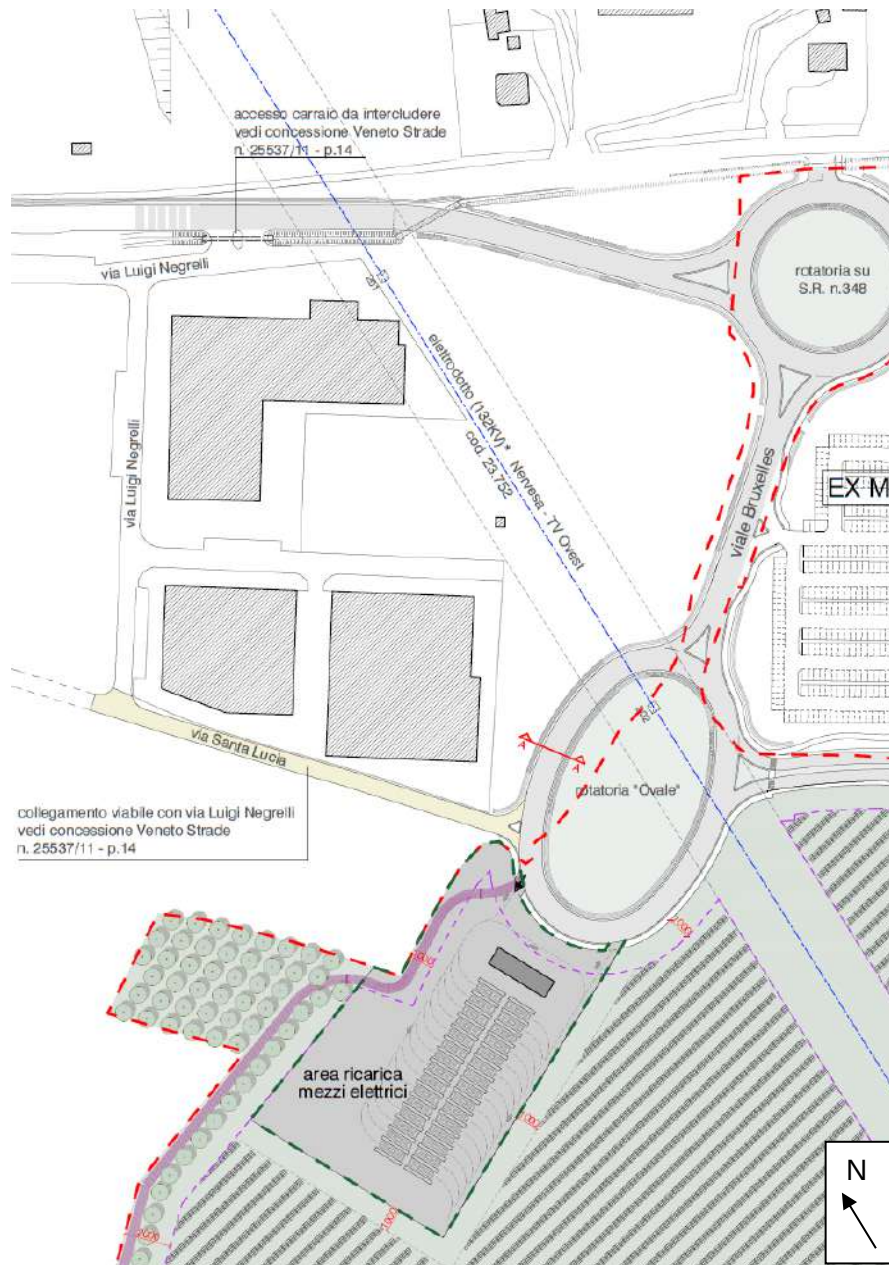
Estratto della planimetria generale d'intervento: nuovo collegamento viario (prolungamento via Santa Lucia) a servizio dell'area produttiva Castagnole '80
